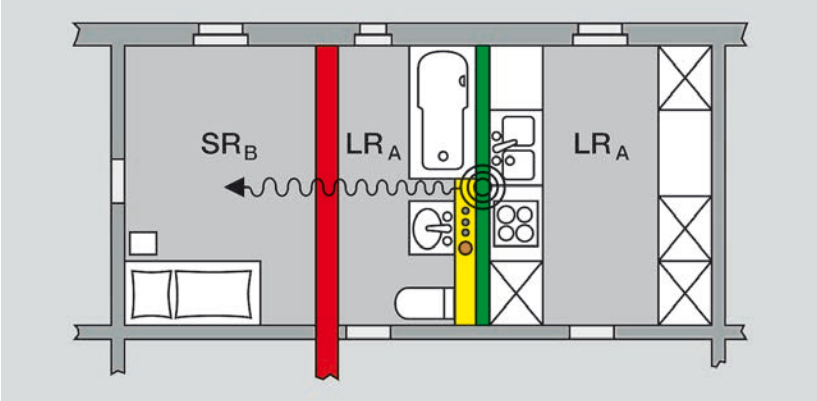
167 Planta favorável referente à acústica arquitetónica
